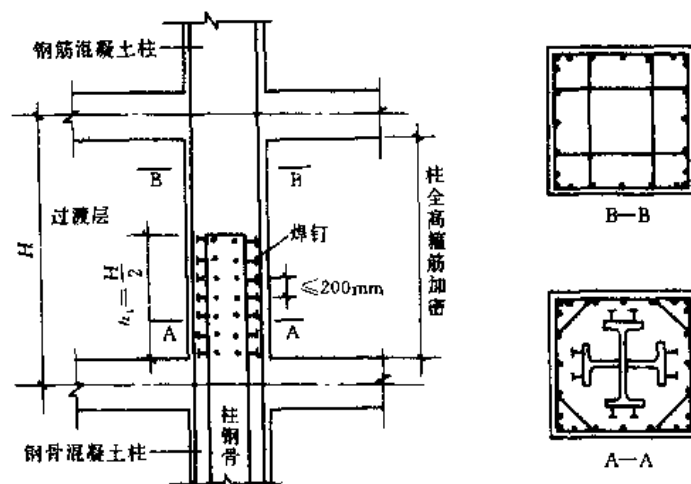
钢骨混凝土柱与钢筋混凝土柱连接的过渡层构造
